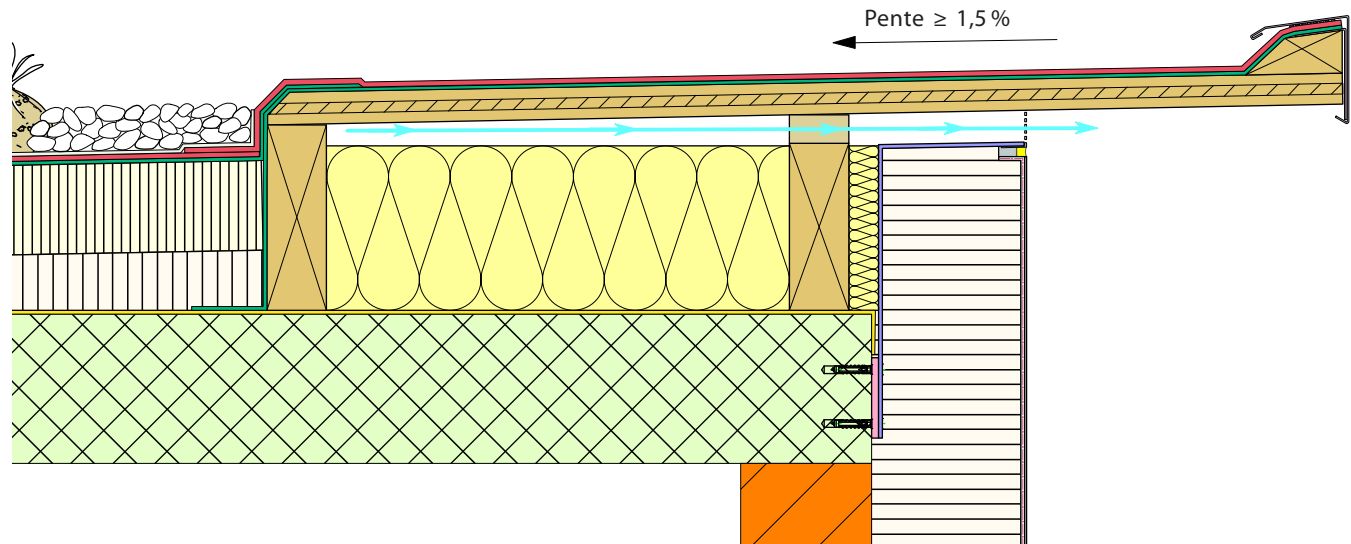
Bord de toit en bois, ventilation minimale, comme toiture nue
